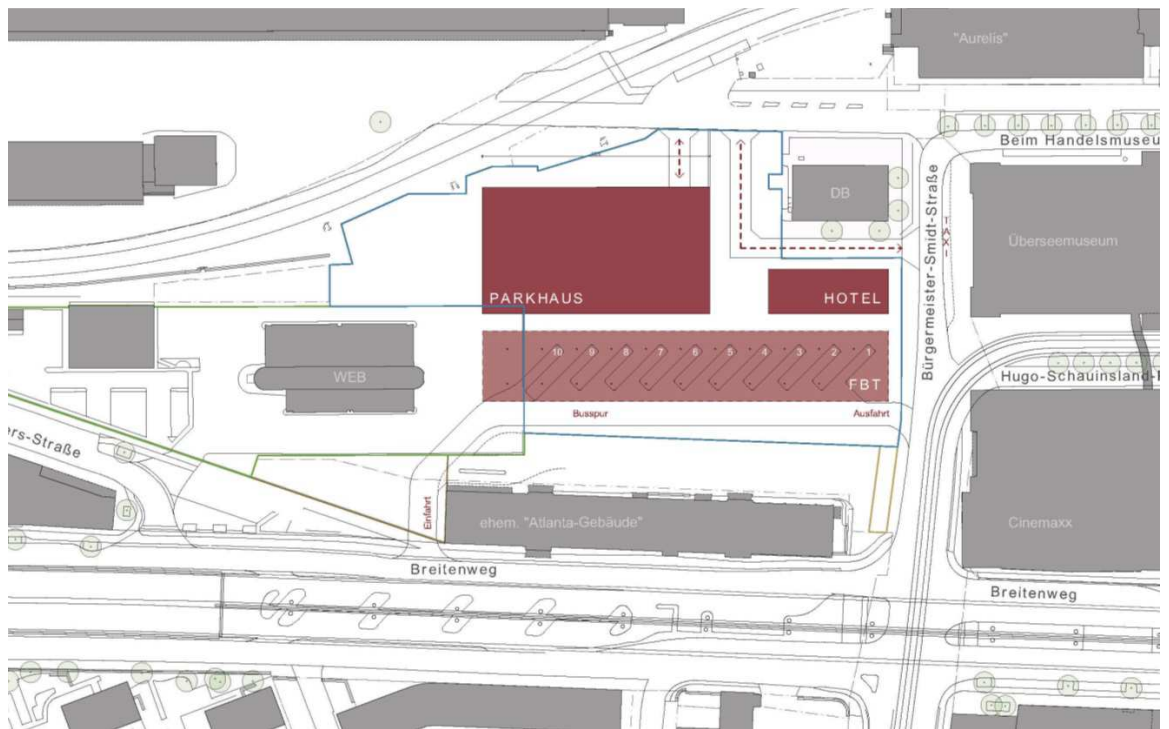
Lageplan Konzept (Quelle: Studie BPR/Westphal Architekten)
